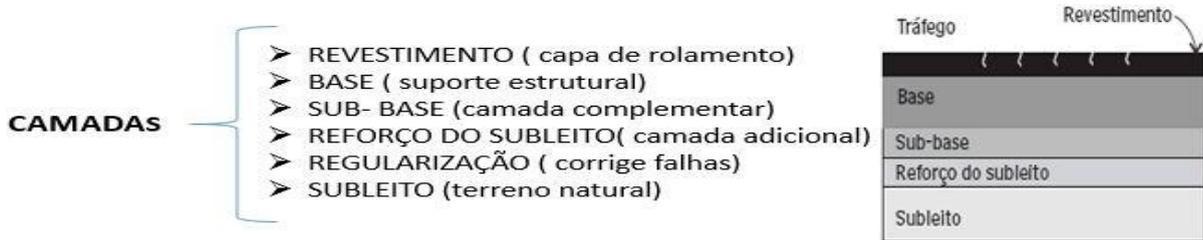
Seção típica de um pavimento flexível em concreto asfáltico
